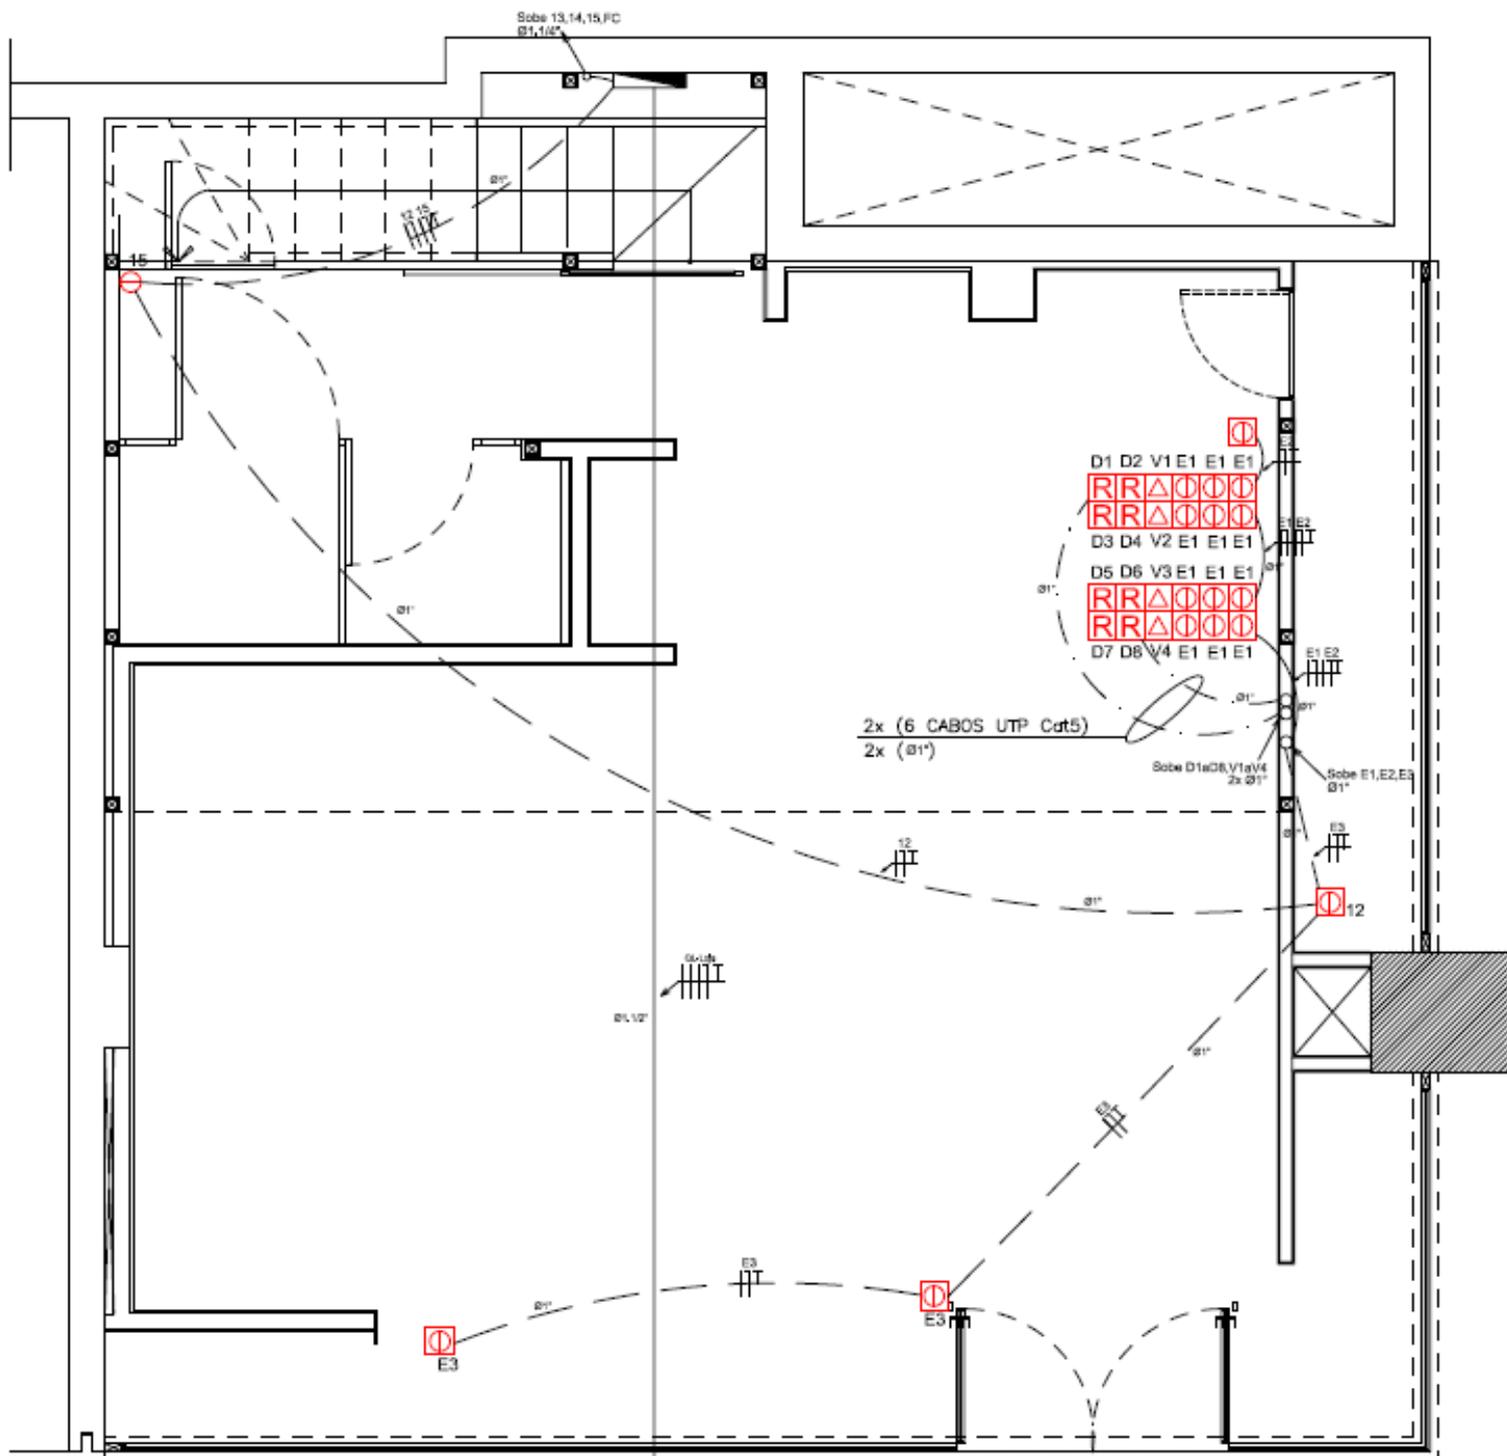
Planta baixa com projeto de iluminação do mezanino da loja Calvin Klein Jeans
